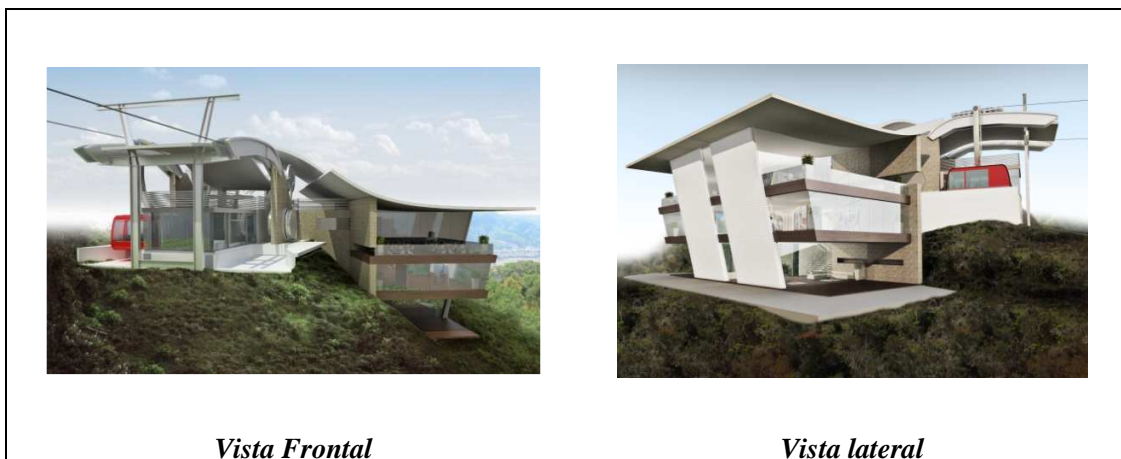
Propuesta arquitectónica para la fachada de la estación. (Sistema teleférico de Mérida, Departamento de ingeniería y construcción, 2011).
